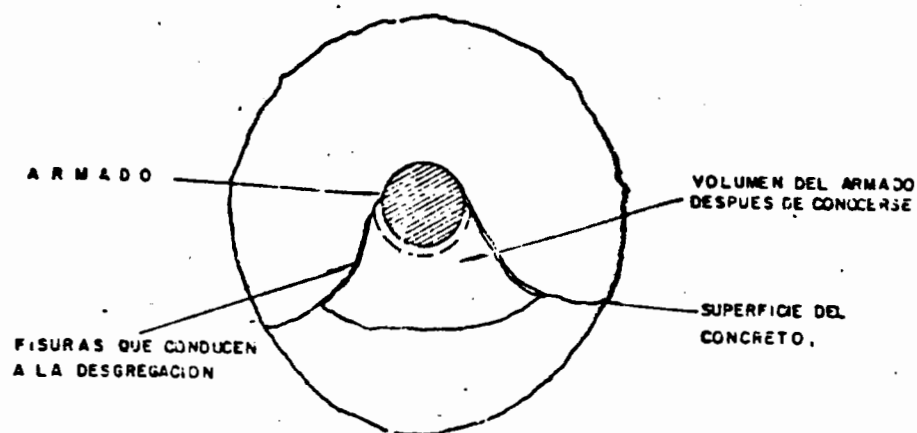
FISURAS EN EL CONCRETO DEBIDO A LA CORRECCION DEL ARMADO
